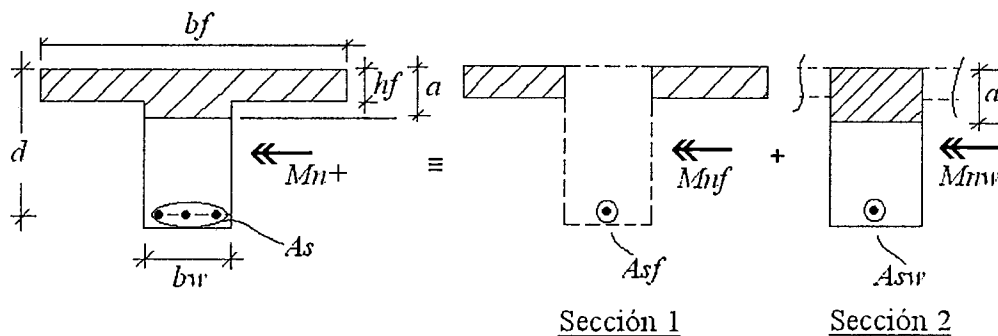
Altura del bloque de compresiones mayor que el espesor del ala
